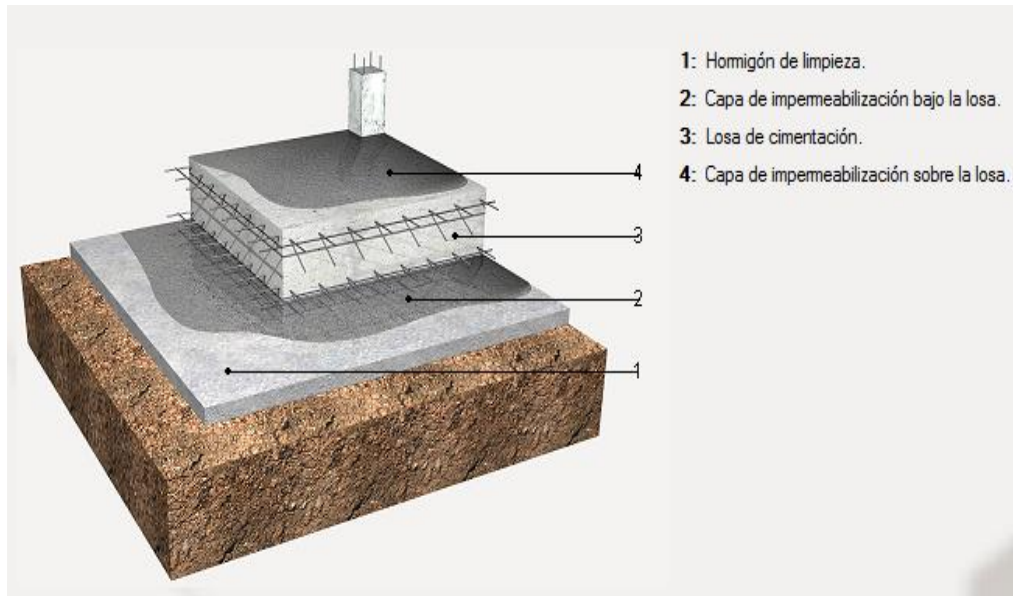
Impermeabilización de losa de cimentación mediante saturación de la red capilar del hormigón.
